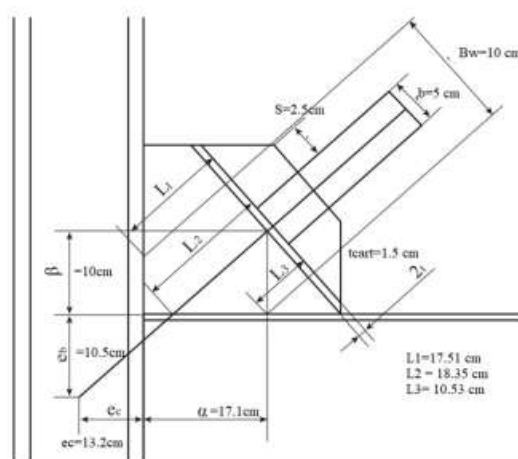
Esquema de conexiones de Arriostramientos corte A-A conexión viga con sección de riostra.
